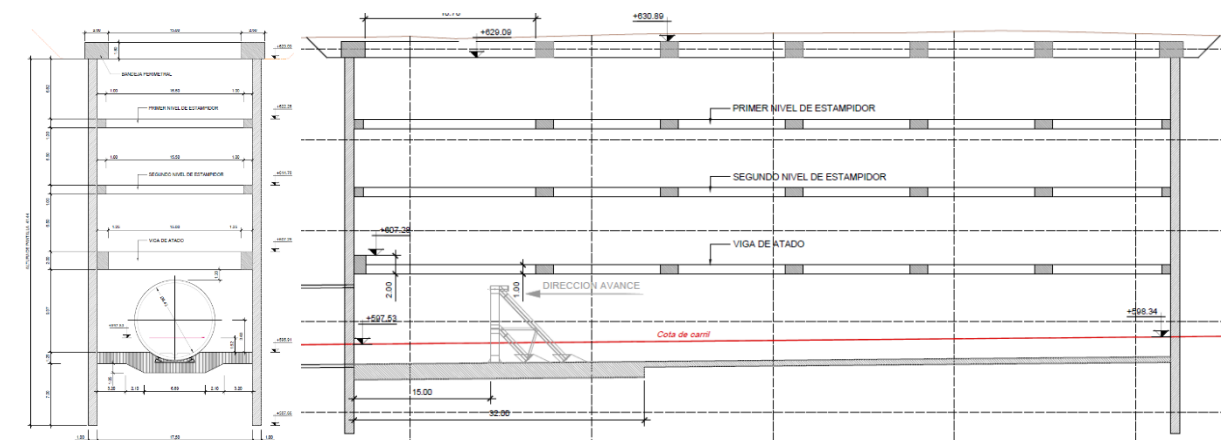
Sección transversal y longitudinal PAT-2 (Alt. 1-3)
